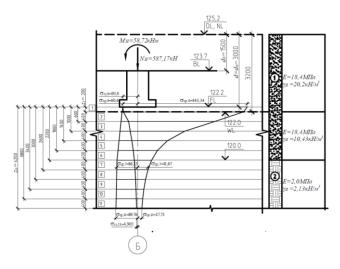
Расчетная схема для определения осадки к примеру 8.4
